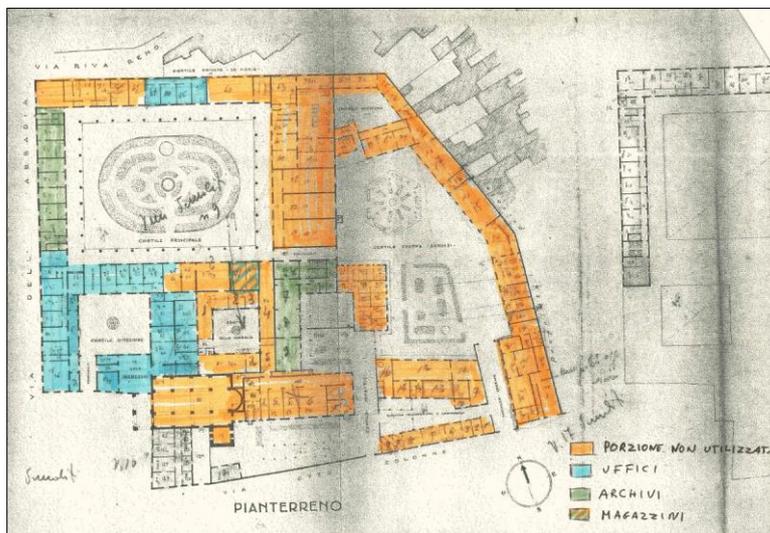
Min. Difesa - *Inventario* – Planimetria del piano terra (1939-1944)
